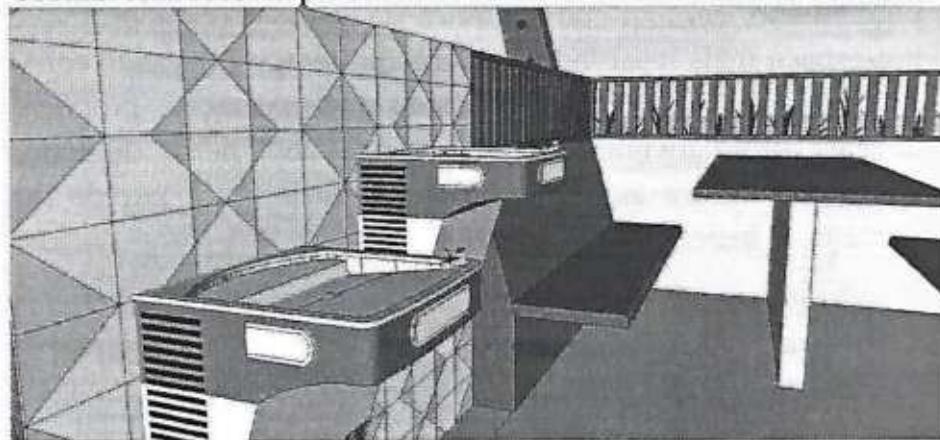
Perspectiva da modelagem da nova proposta da Estação Urbana com foco na mesa em concreto armado
